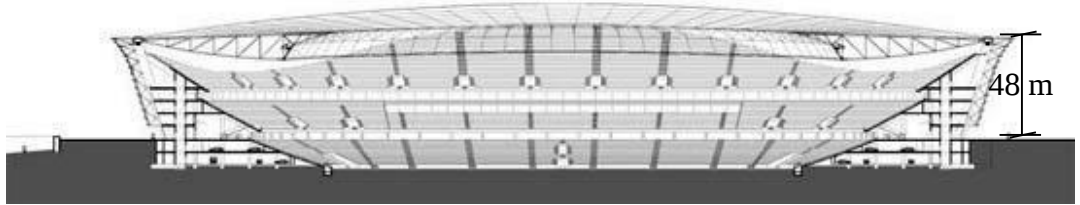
Green Point Stadyumu detay kesiti (Capetown, b.t)
